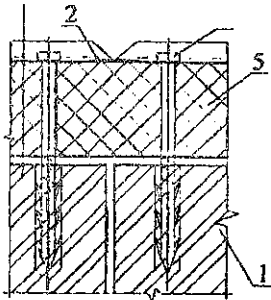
Система утеплення стін з оштукатурюванням фасадів з жорсткими кріпильними елементами
